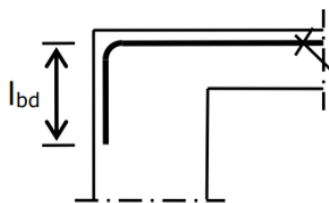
Amarração de armadura superior em apoio de encastramento (Félix et al., 2014)
